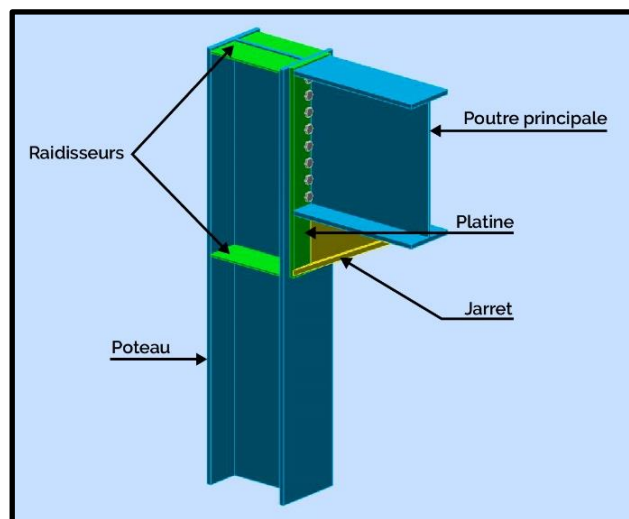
Assemblage poteau HEA 400 – poutre IPE 600 [Autodesk Robot Structural Analysis Professional]
